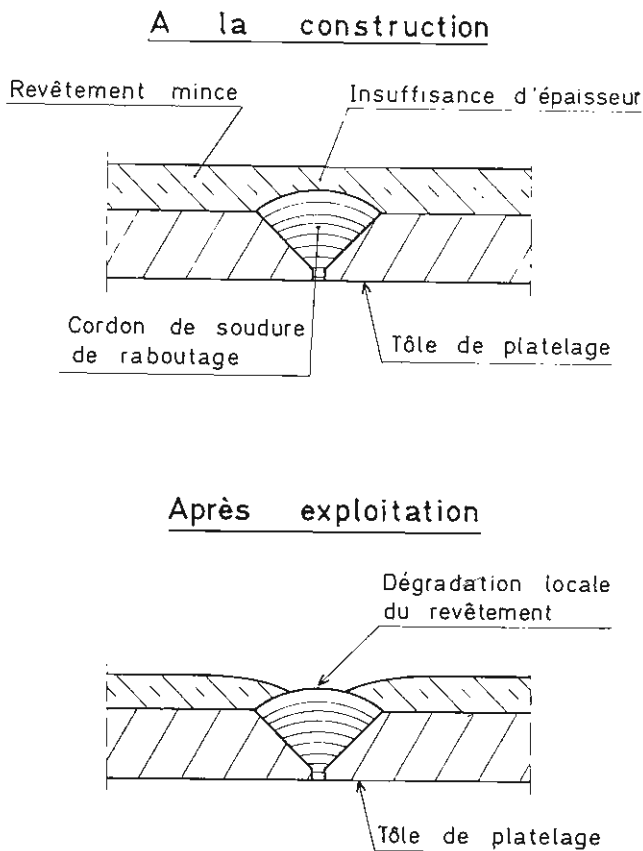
Nécessité de l'arasement des cordons de soudure de raboutage devant être recouverts par un revêtement mince.
